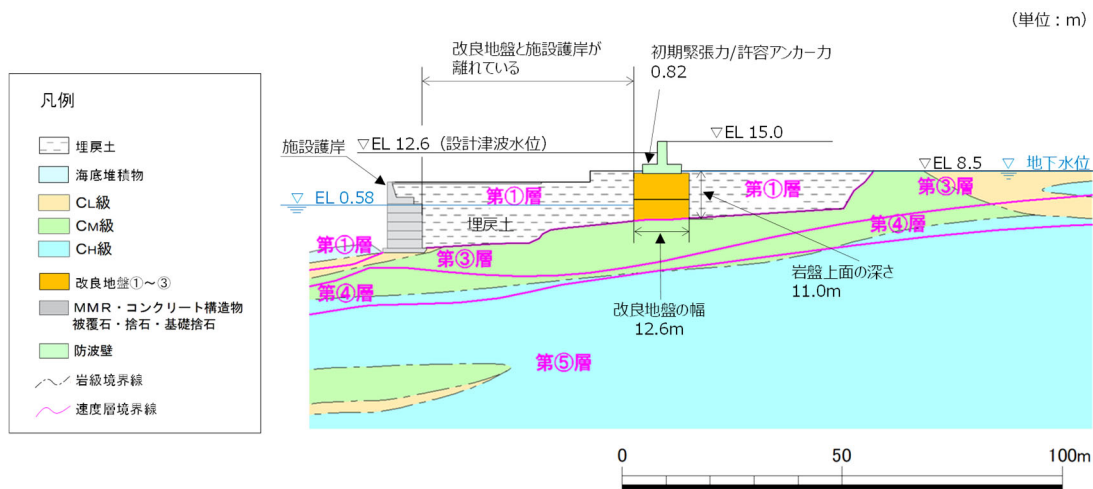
防波壁（逆 T 擁壁）の横断面図（⑥-⑥断面）
